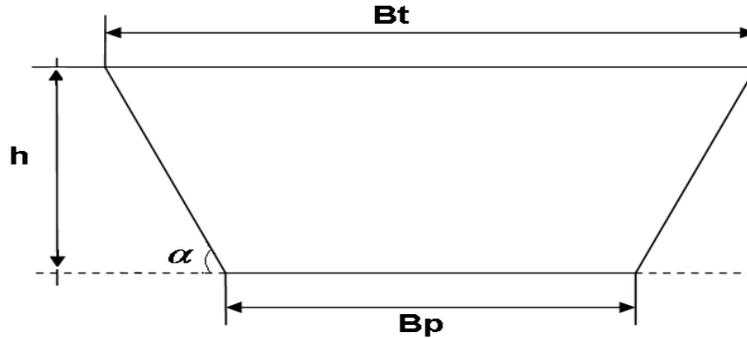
Perfil transversal de la trinchera de acceso y corte
